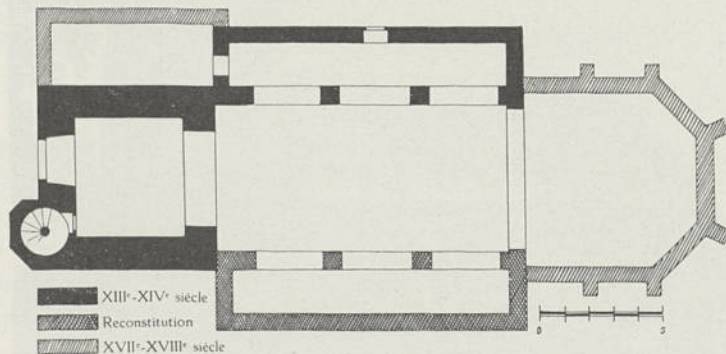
Molenbeek, Eglise Saint-Laurent, plan terrier
